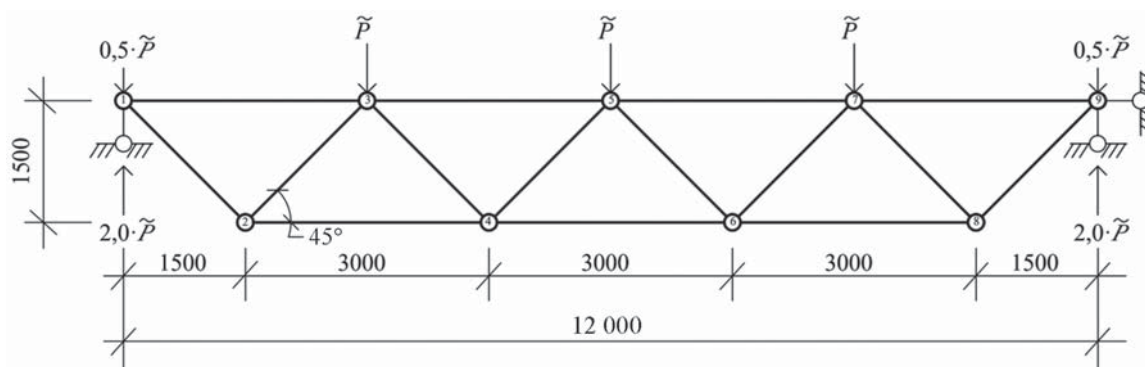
Расчетная схема фермы со случайной нагрузкой \tilde{P} Fig. 5. A design pattern for a truss exposed to random \tilde{P} load
